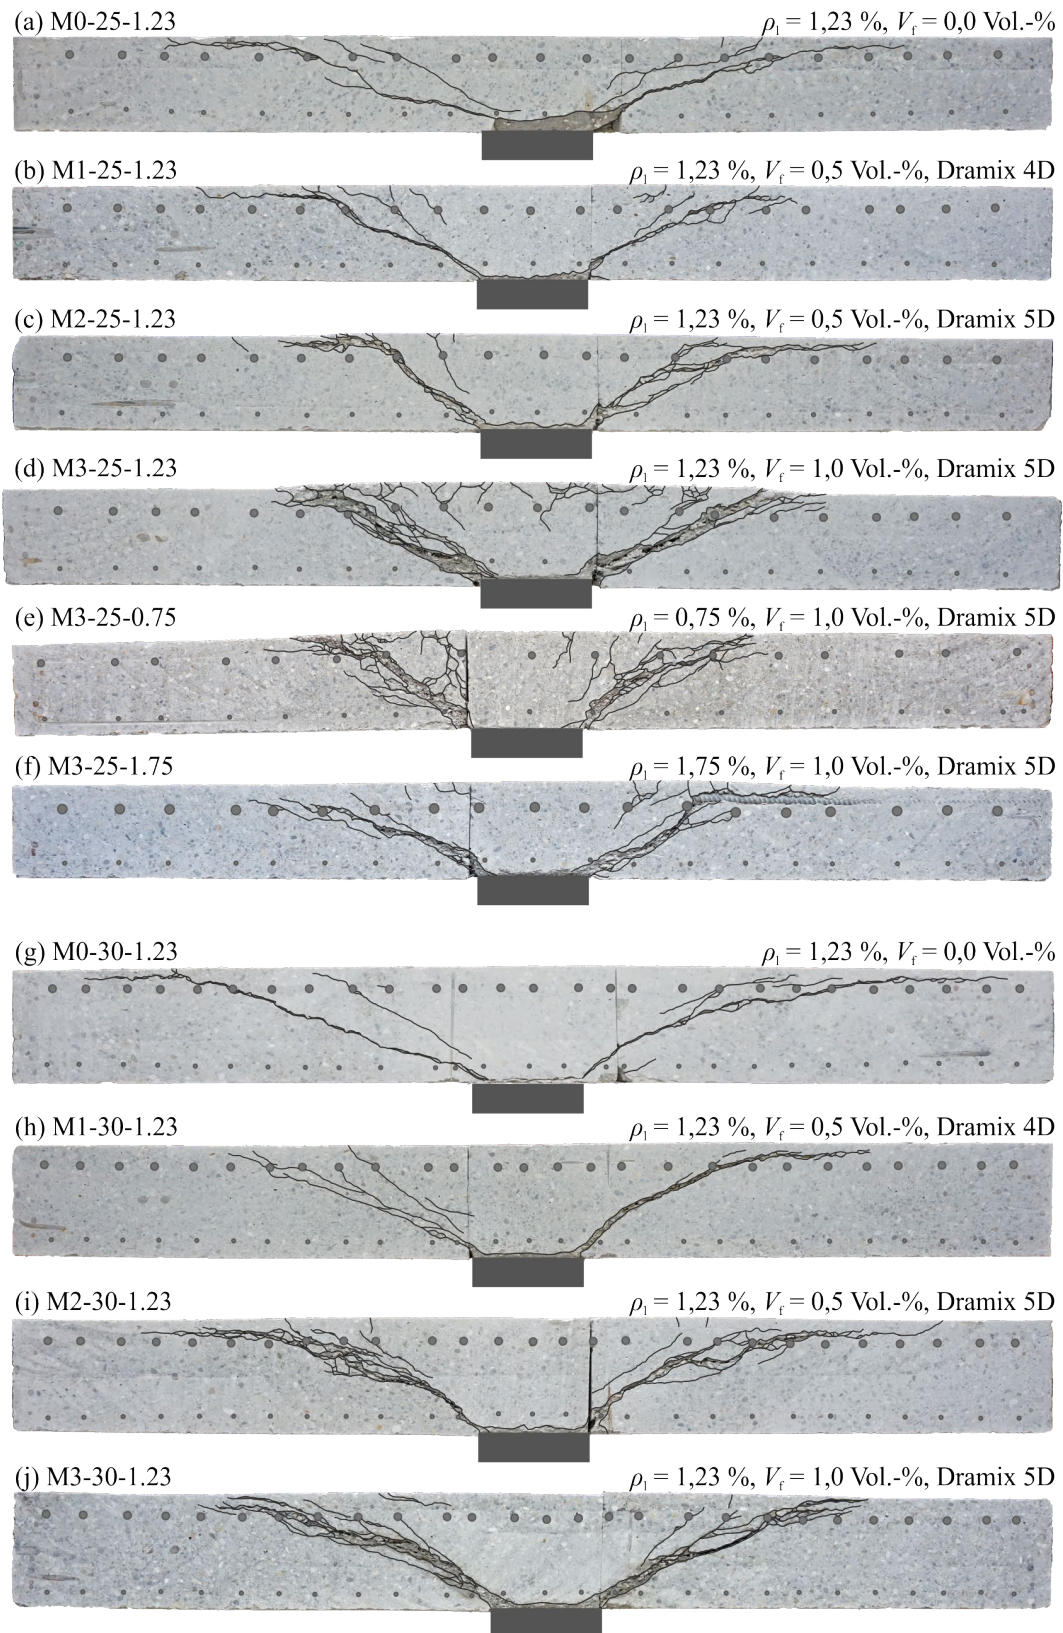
Trennschnitte der geprüften Flachdeckenausschnitte ohne Durchstanzbewehrung
